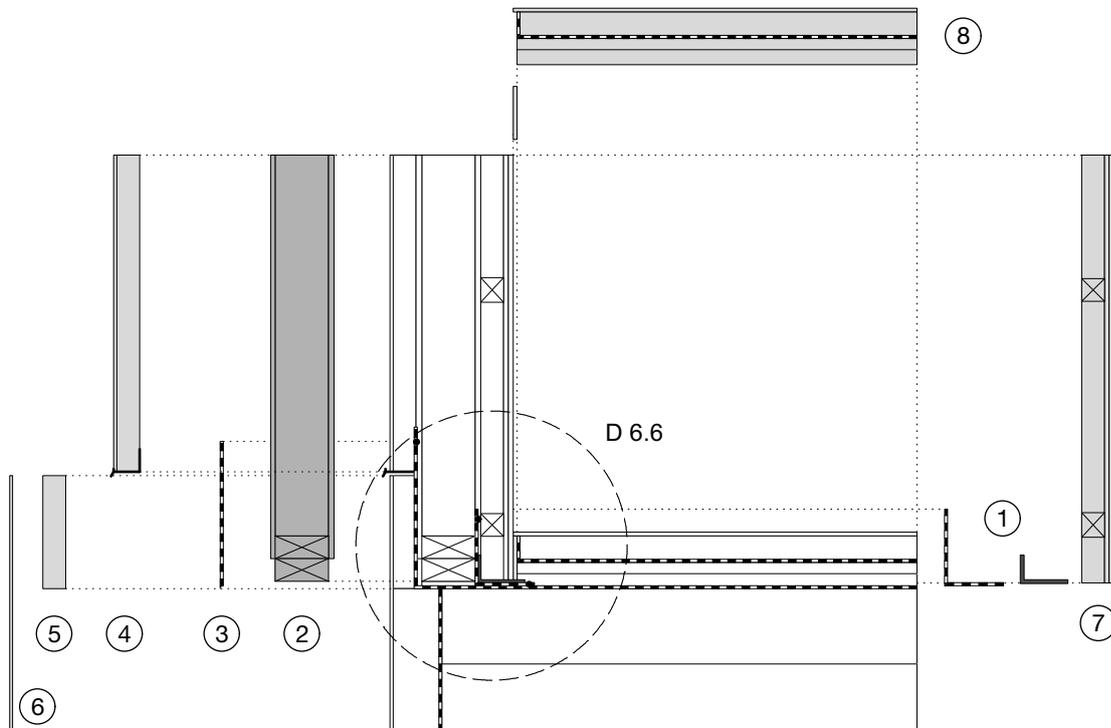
Montagereihenfolge - Ebenerdiger Anschluss Bodenplatte - Außenwand, teilweise eingestellt
